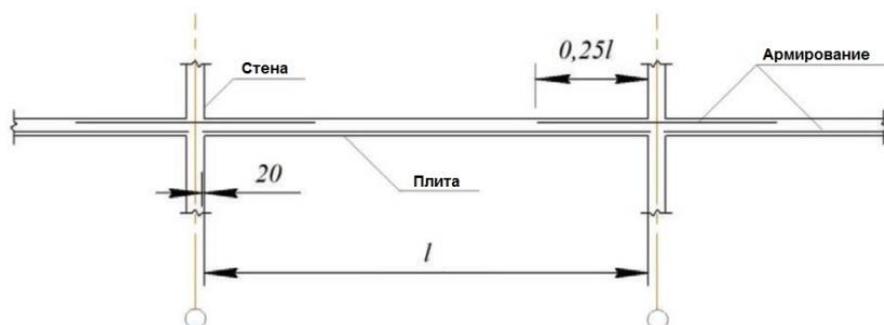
Вариант конструктивного решения монолитного перекрытия при строительстве стеновой структурной системы
